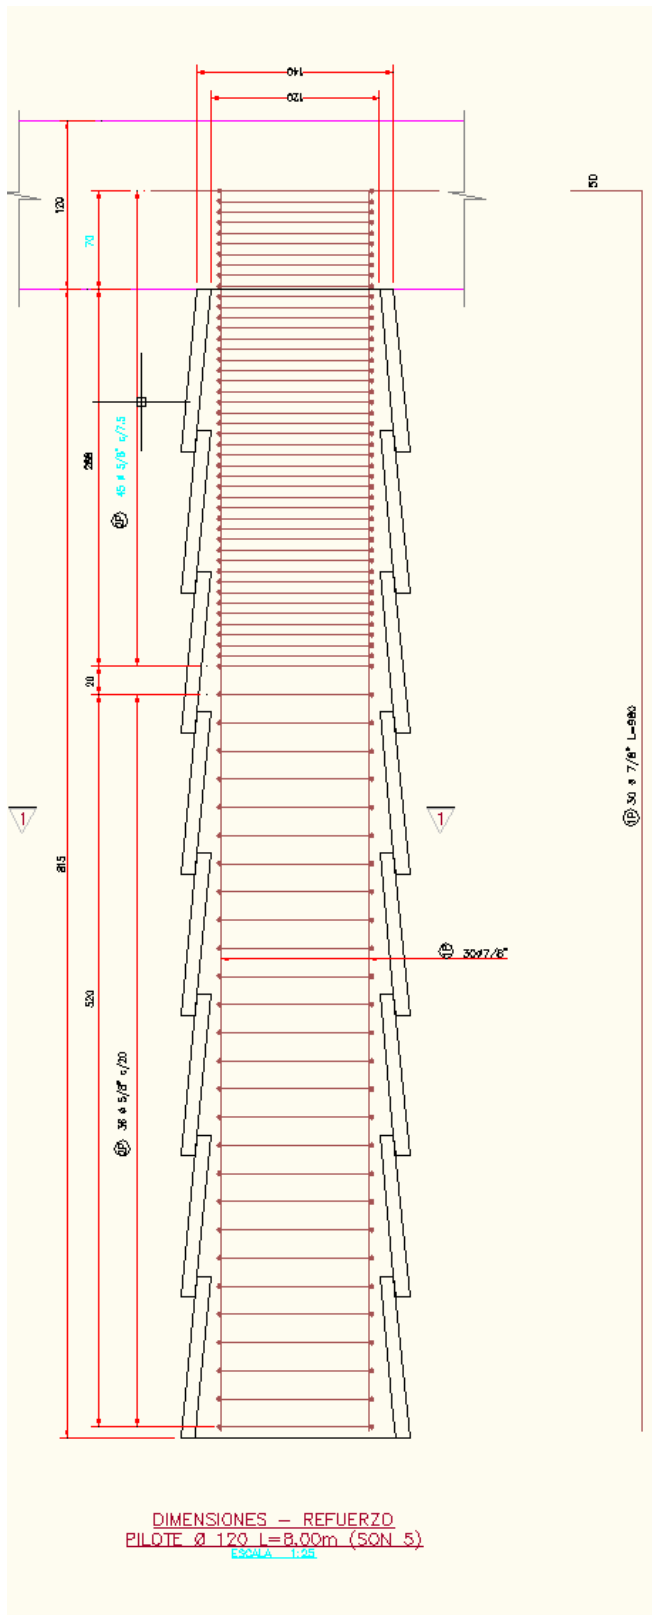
DETALLE DE REFUERZO PRINCIPAL.
